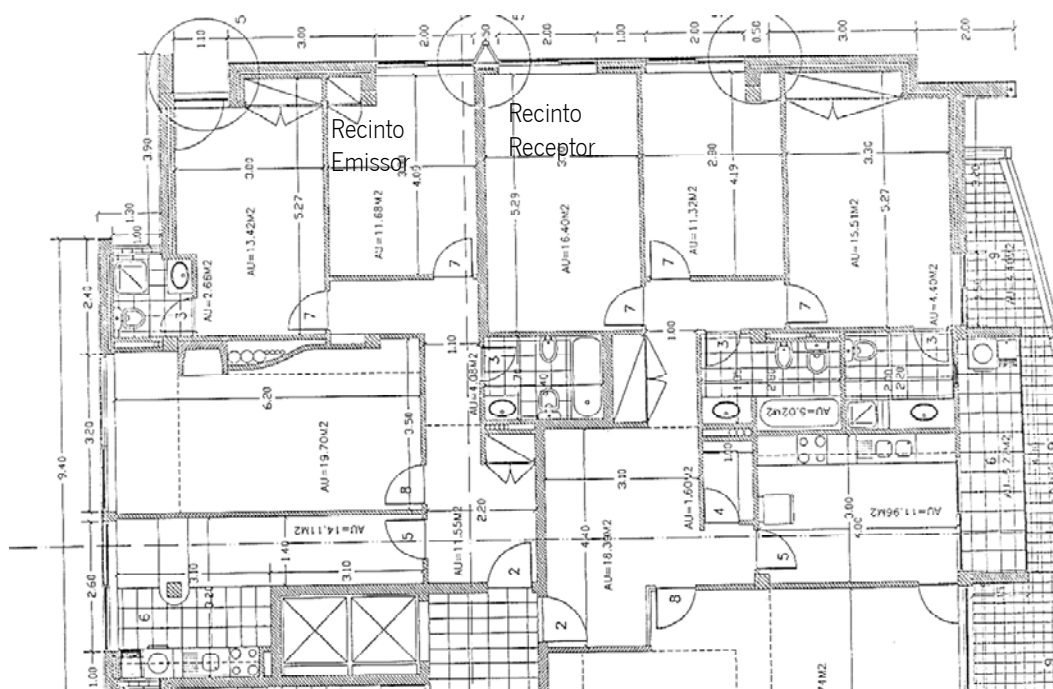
Planta do recinto emissor e do recinto receptor do ensaio de avaliação do isolamento da parede interior Parl1
